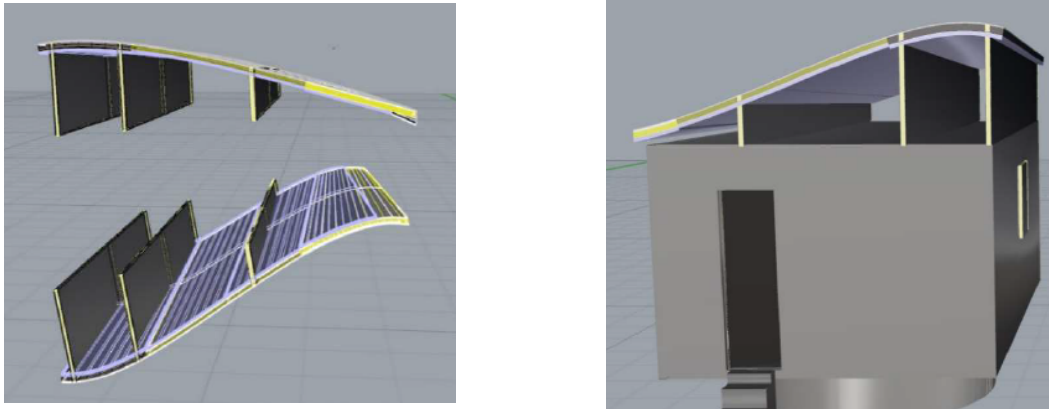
Sistema Roof Frames da parte lateral da pá.
